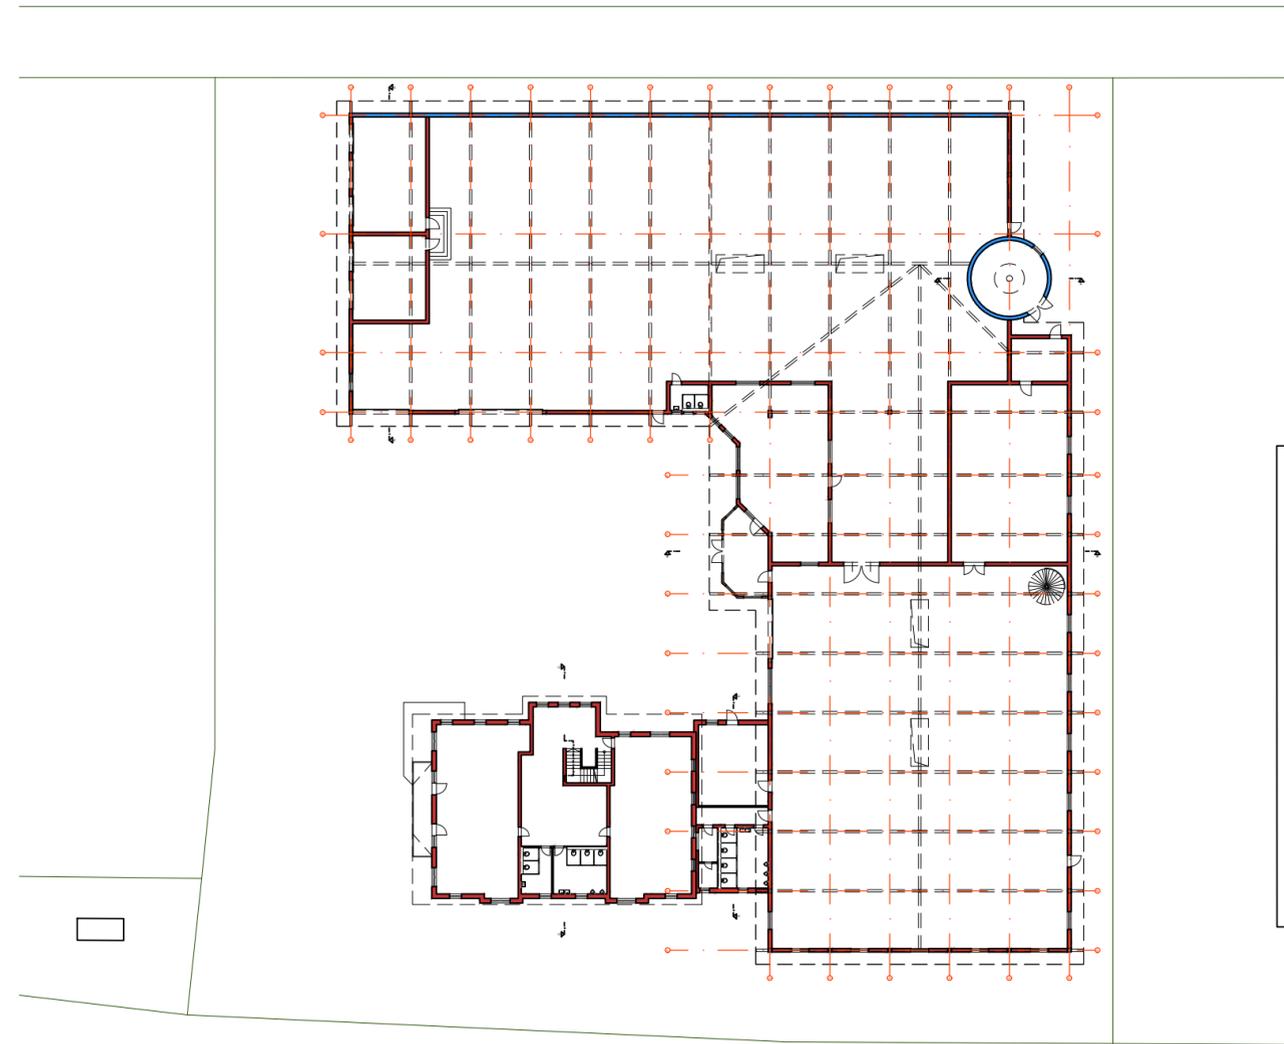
Grundriss Obergeschoß lt. Einreichung 1995
